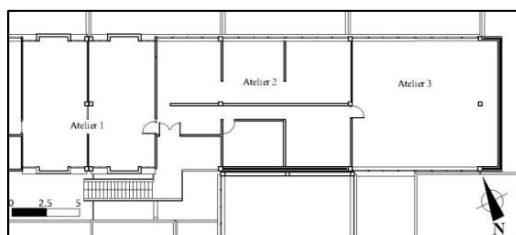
Exemple de plan d'atelier au 2ème étage
